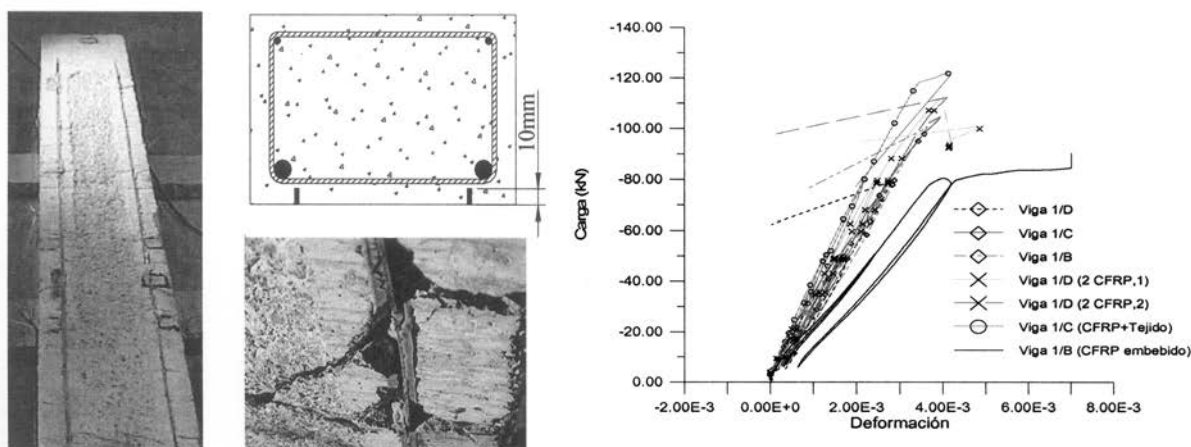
Viga 1/B con dos laminados CFRP (10 x 1.4 mm) embebidos en hormigón. Carga vs deformación máxima en el laminado para las vigas tipo 1.
